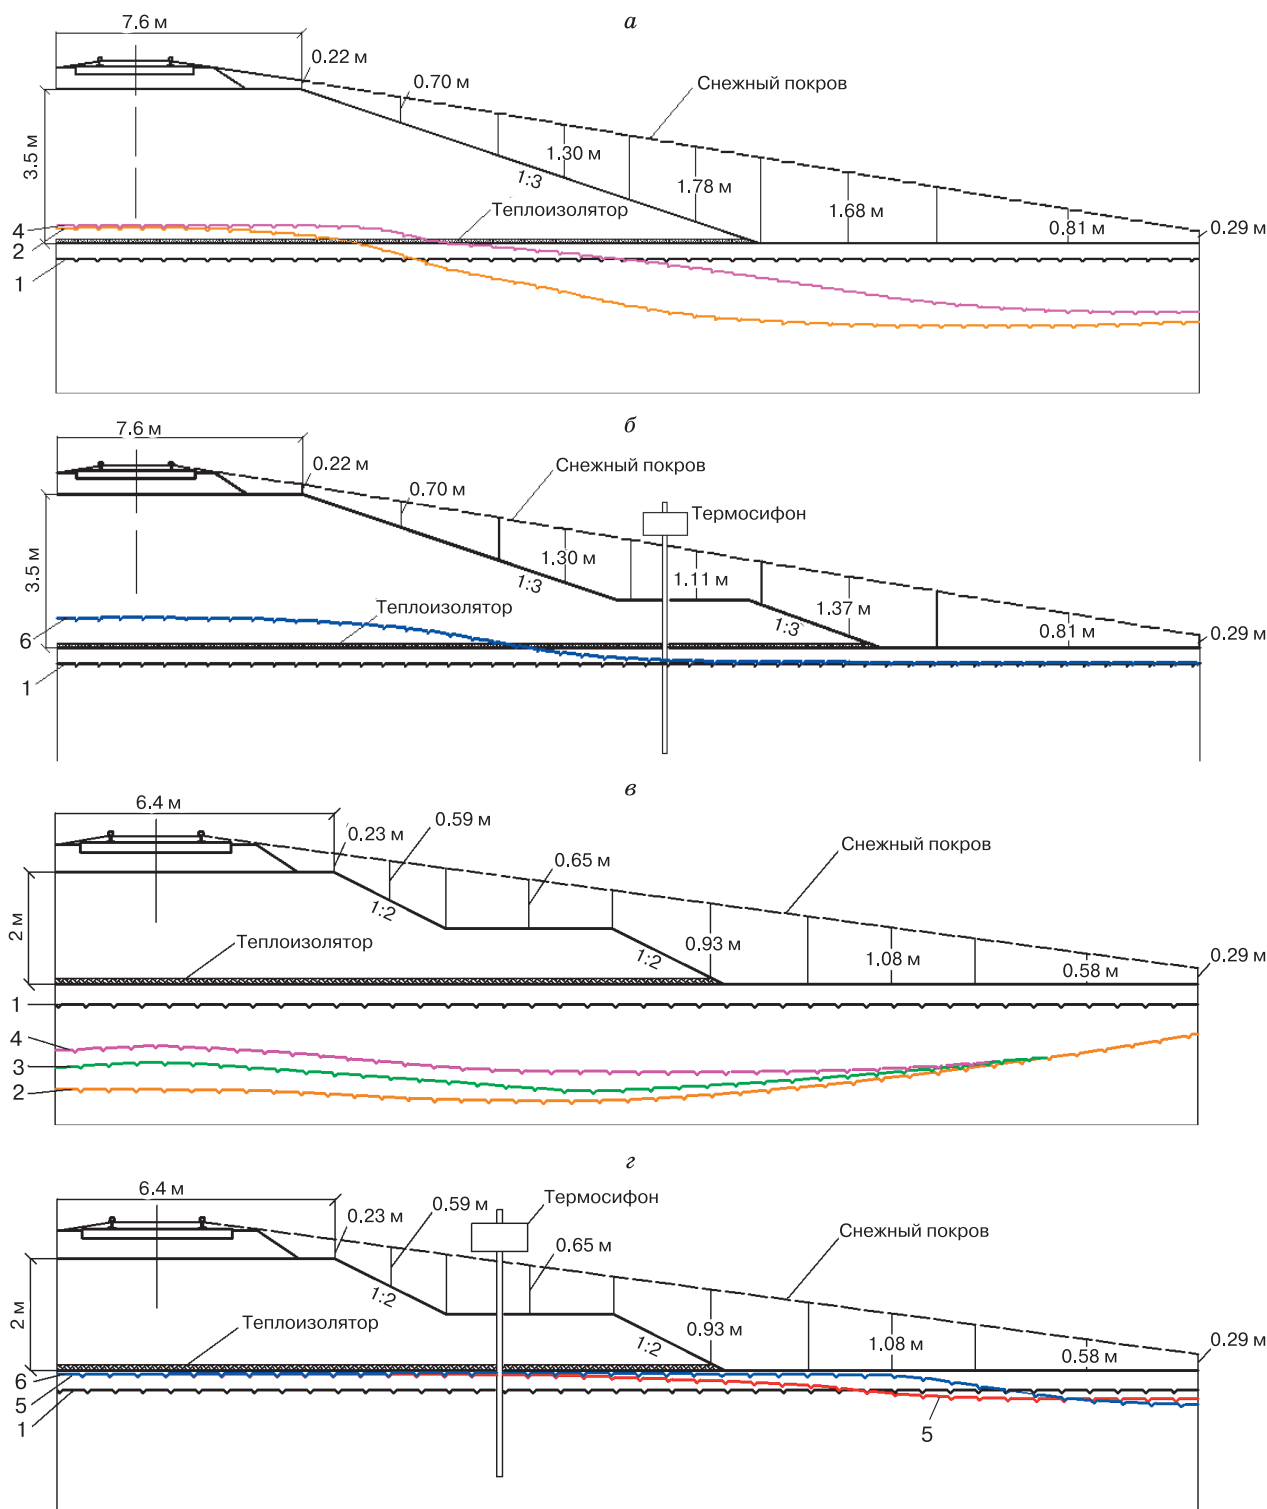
Положение кровли ММГ на расчетных поперечниках линии Салехард–Надым:
